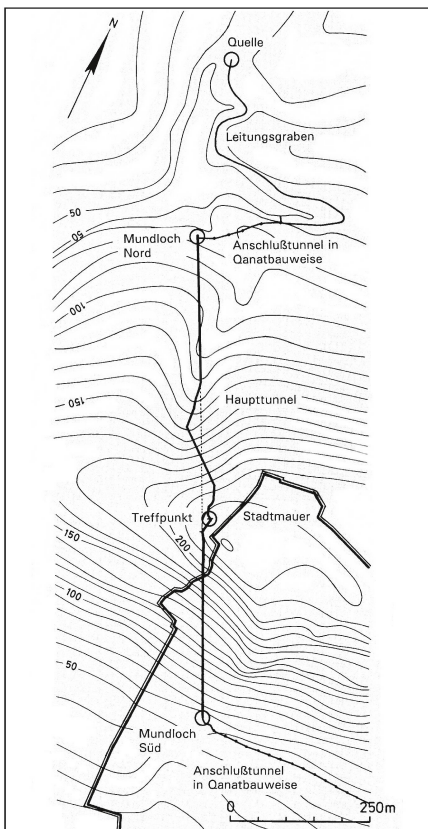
Lageplan des Eupalinos Tunnel (n. Kienast, H., 1977 und. Grewe, K., 1998, S. 59).
